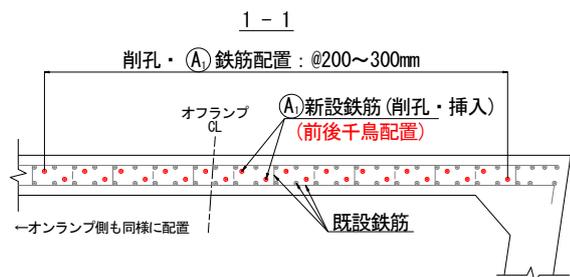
A<sub>1</sub>鉄筋の配置(平面図)
